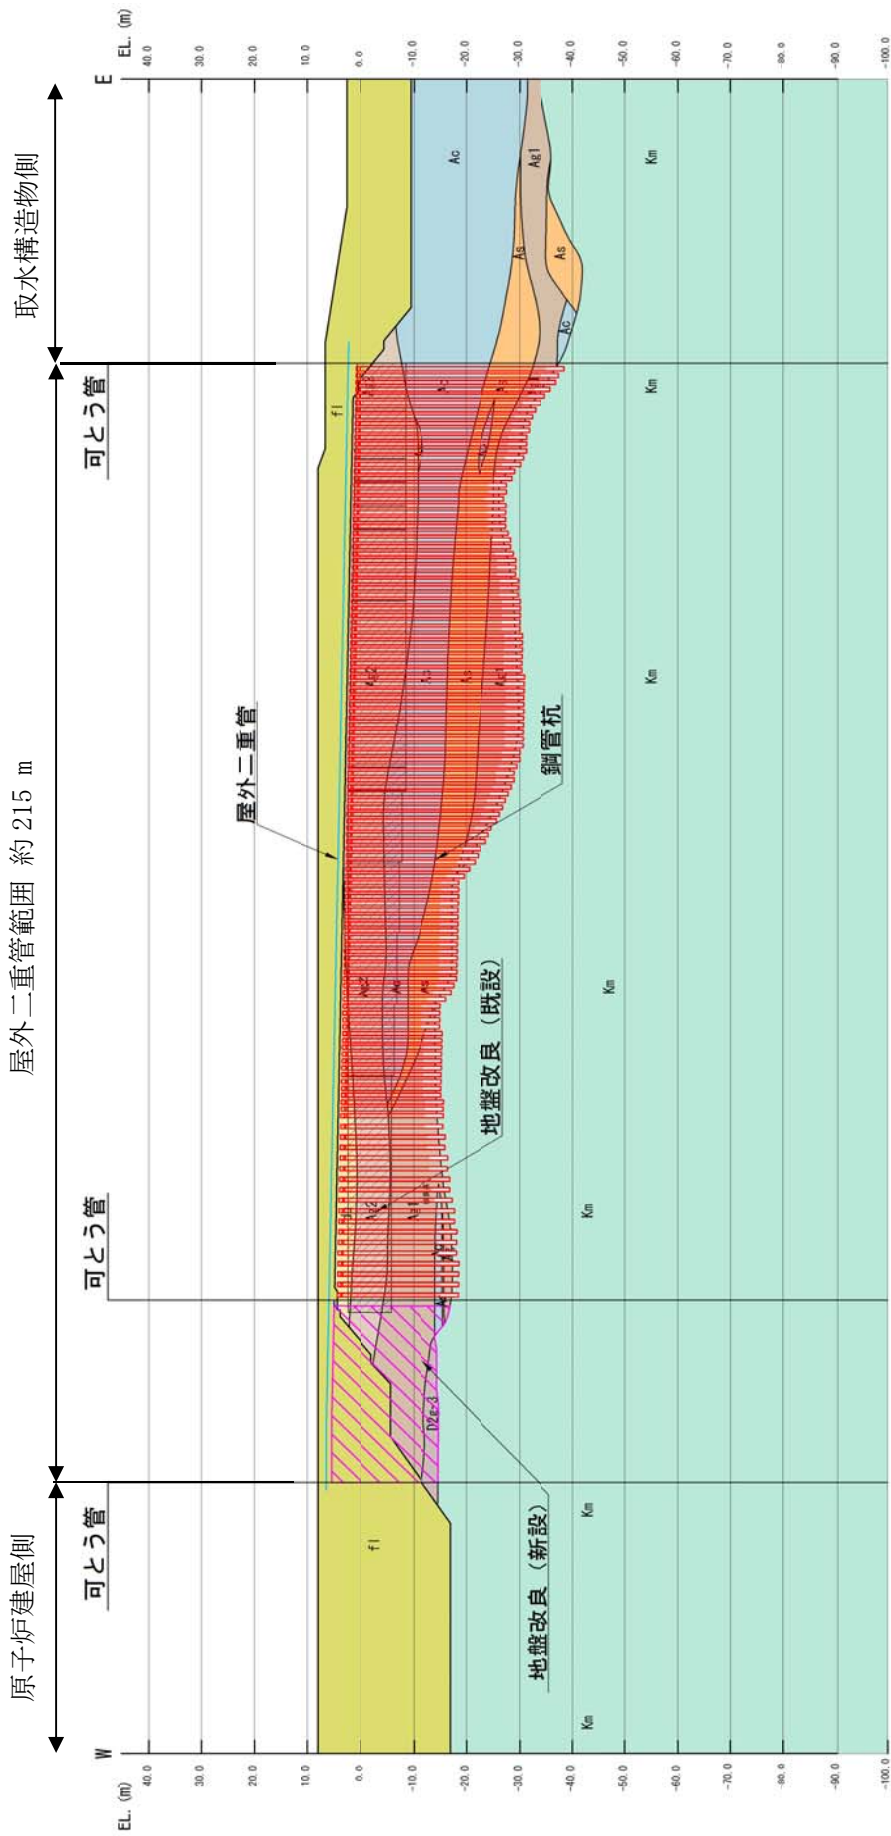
(1) 屋外二重管の縦断面図 (A-A断面)
